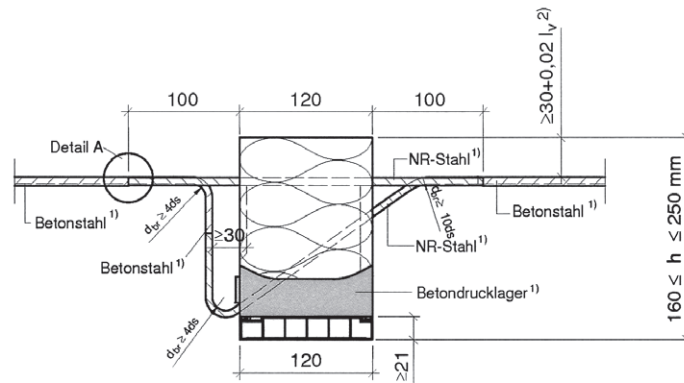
Beispiel Schöck Isokorb Typ RK-240 mit Druck- Querkraft Kombination integrierter Aufhängebewehrung und Drucklageraufhängung
